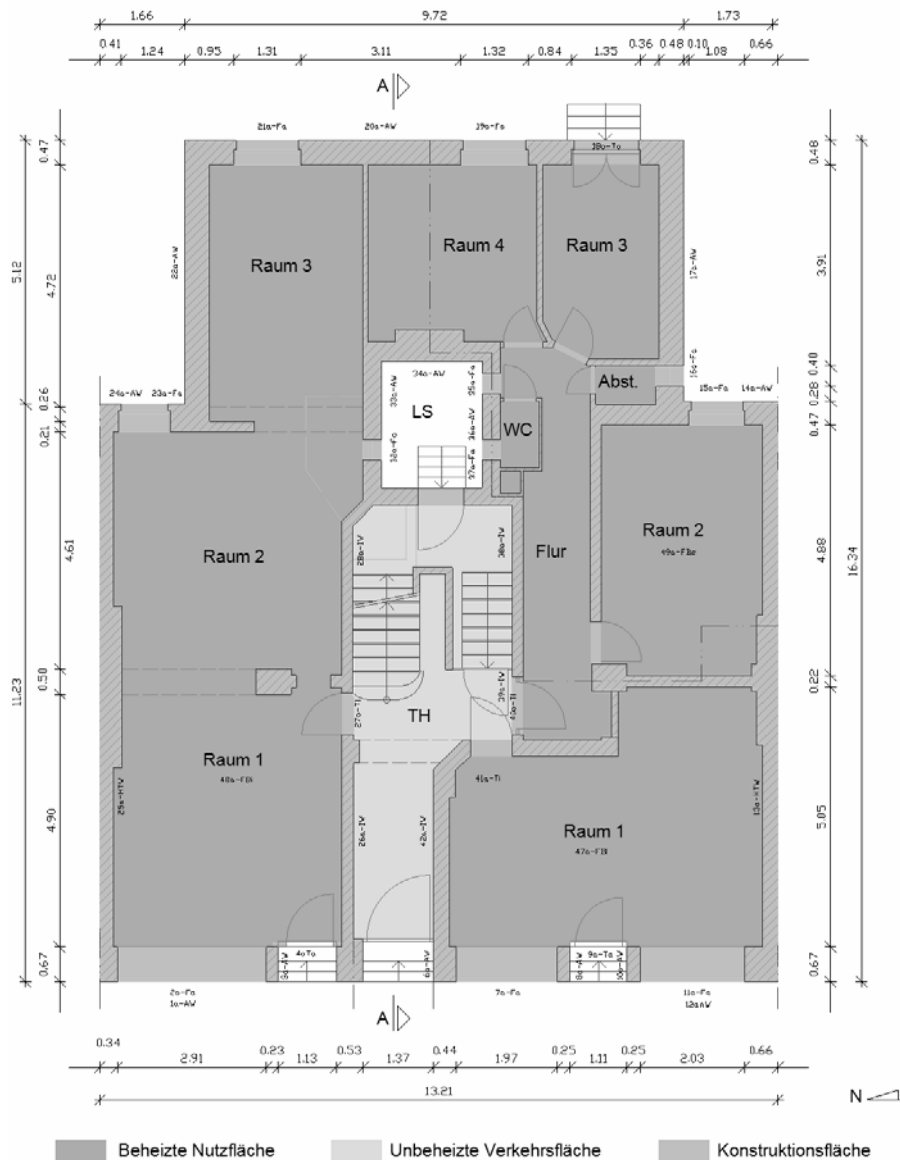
Grundriss EG mit Systemgrenzen, Flächen und Bauteilzuordnungen
